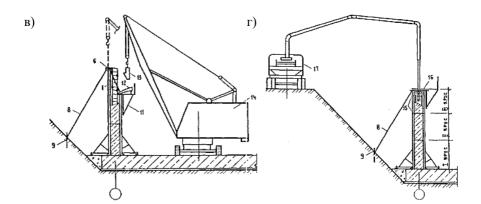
Схемы производства опалубочных, арматурных и бетонных работ при возведении монолитной стены
